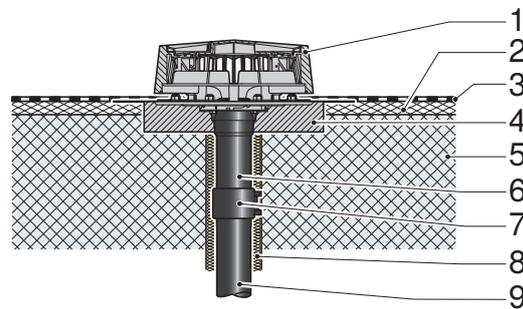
Монтаж на неизолированной жесткой кровле с кровельным покрытием
